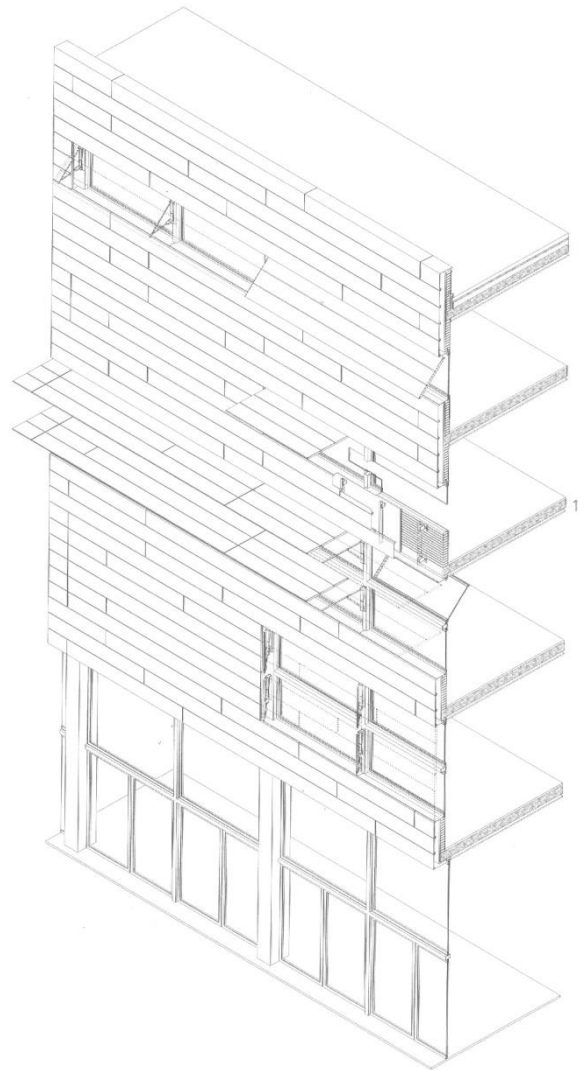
Axonometría constructiva de fachada tipo de lamas móviles. Fuente: Revista Tectónica nº4.
